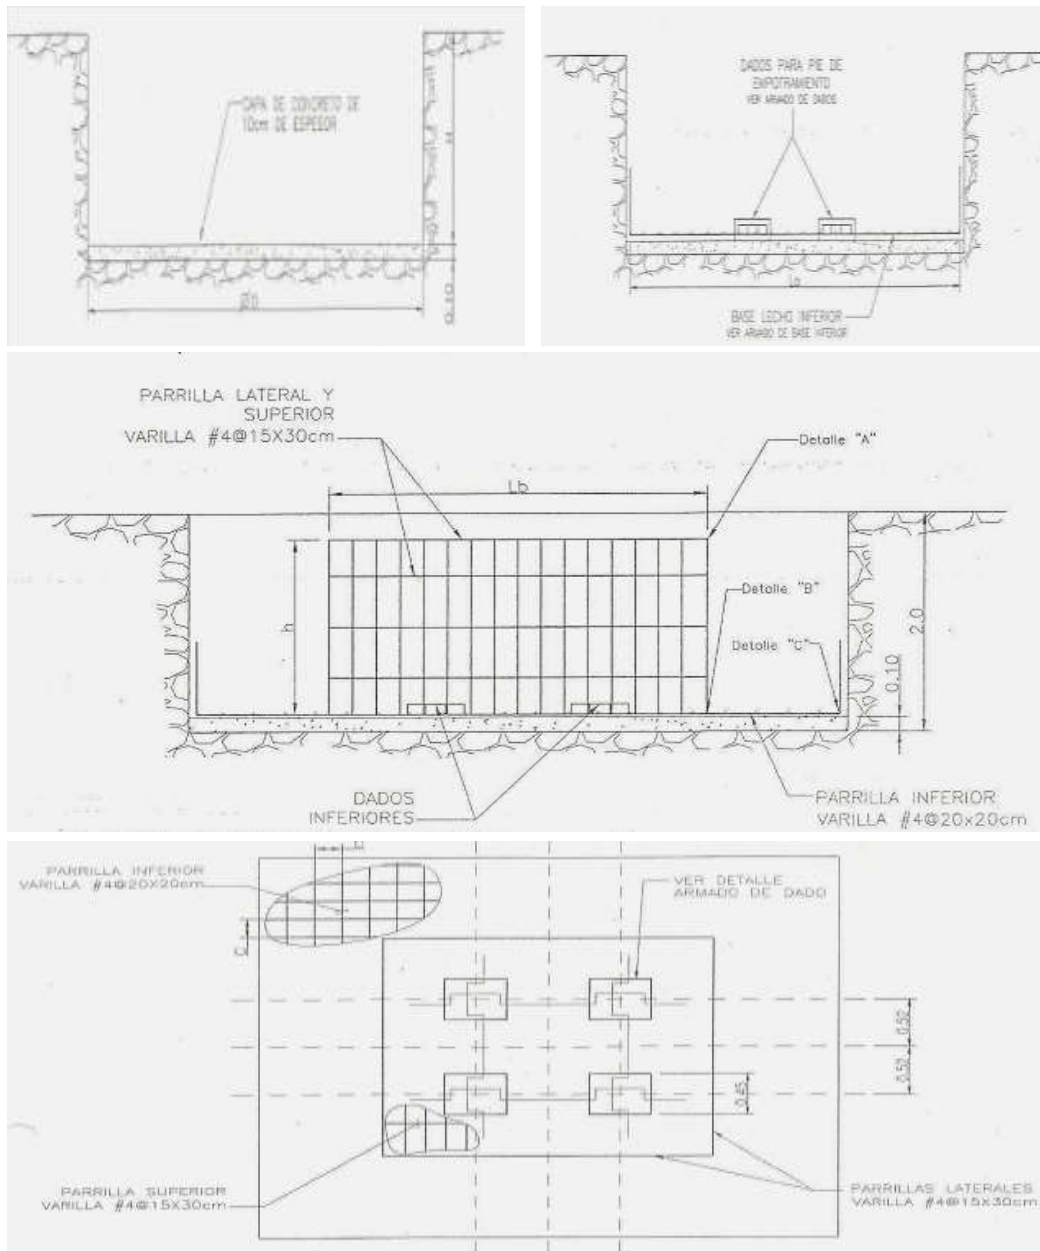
Procedimiento de Armado de la Cimentación de la Grúa Torre
